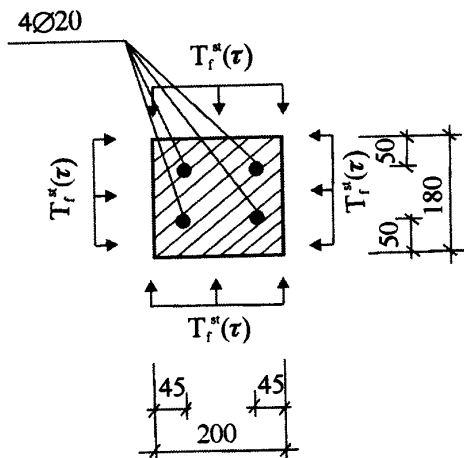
Поперечное сечение нижнего пояса заданной железобетонной формы и схема воздействия пожара на этот элемент.
